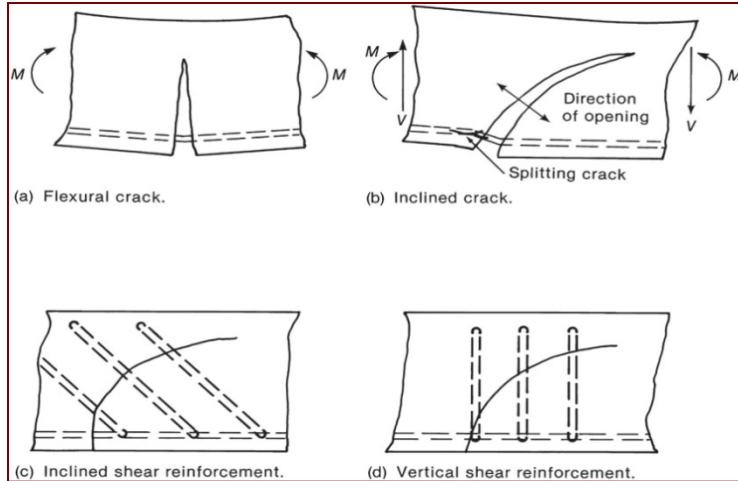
Grietas inclinadas y refuerzo de cortante.
